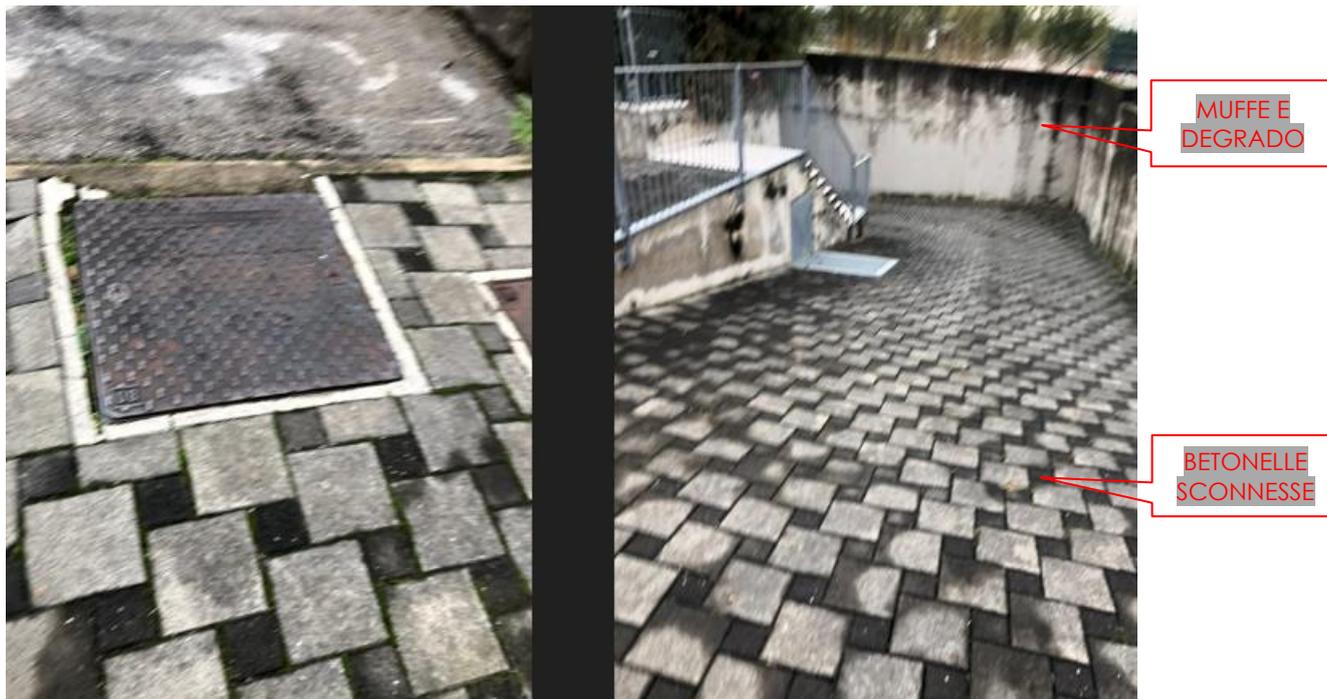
Pavimentazione parti comuni in asfalto e betonelle
